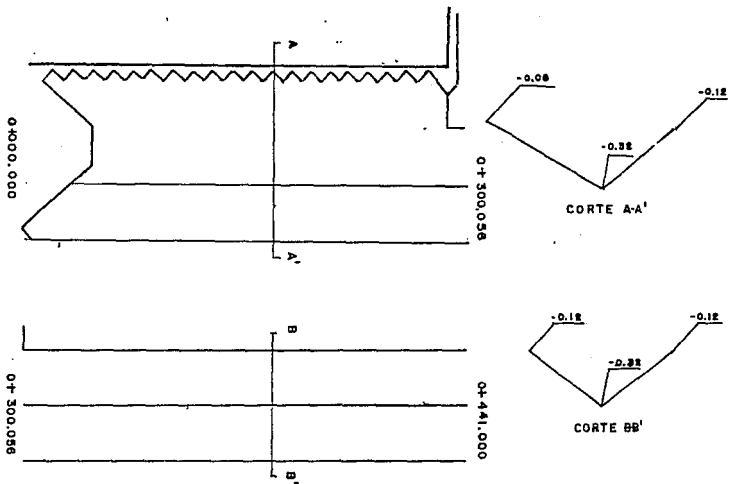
DETALLE SECCIONES QUE COMPRENDEN LA AV. 2 SUR
